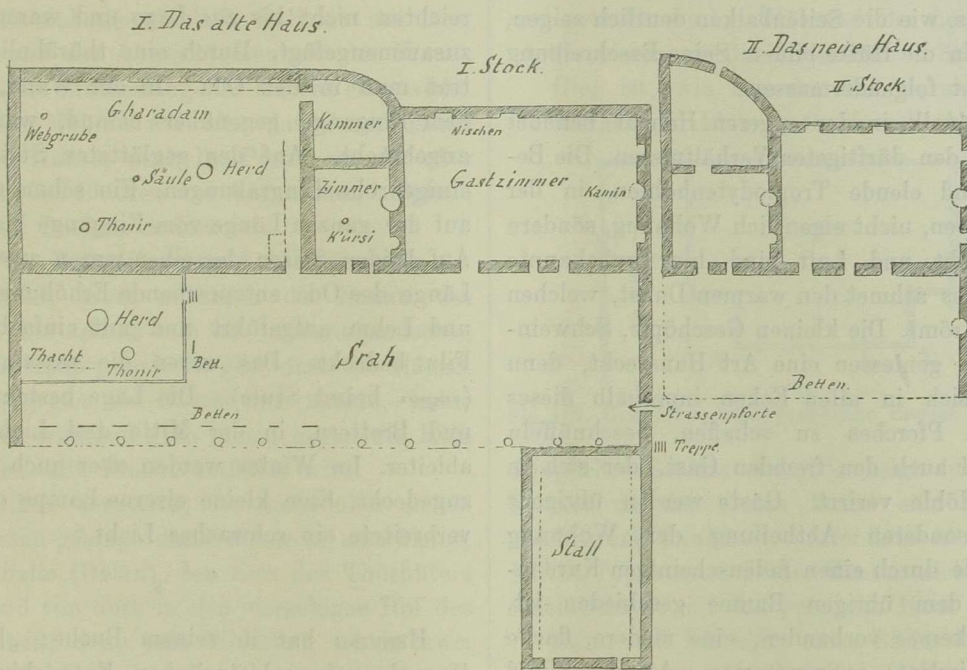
Grundriss eines Hauses aus dem Dorfe Schikahogh.
